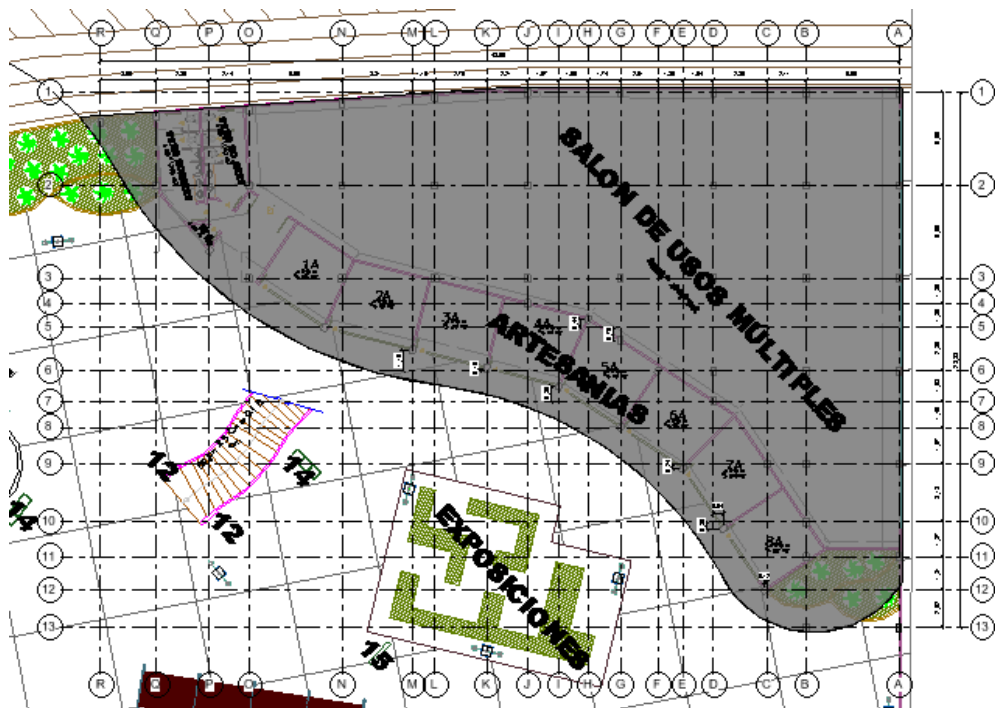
Vista en planta de Terraza 1. (Bodero & Romero, 2022)
